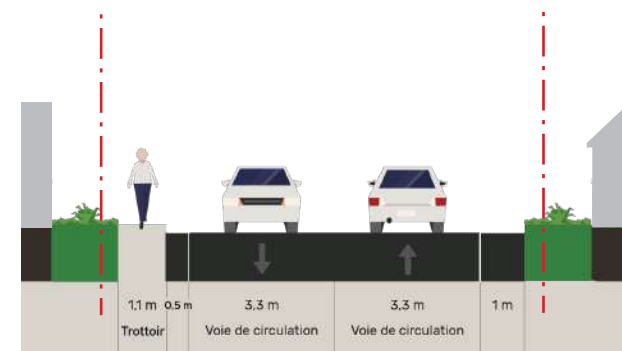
COUPE SCHÉMATIQUE DE L'EMPRISE DE LA RUE PRINCIPALE EXISTANTE
